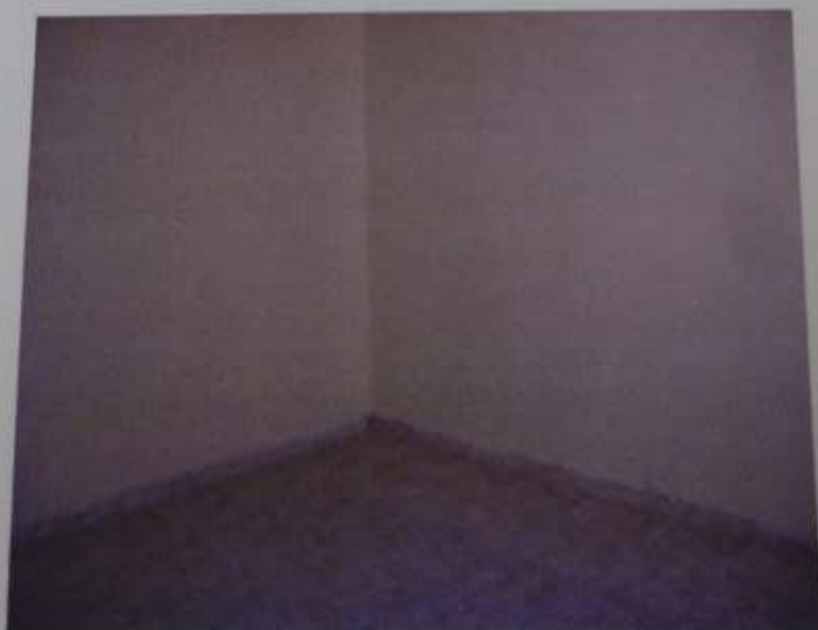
Vista interna do imóvel avaliando. Dormitório.
